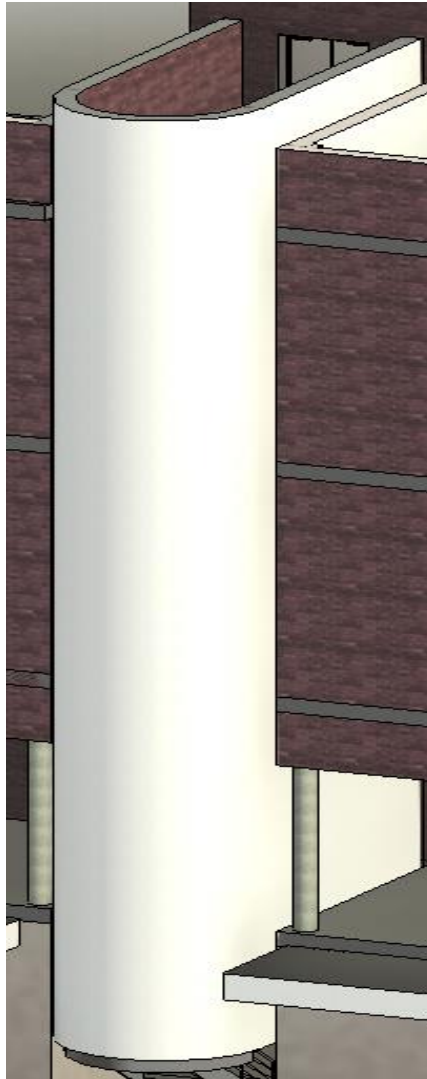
Vista 3D del muro que será transformado en estructura metálica
